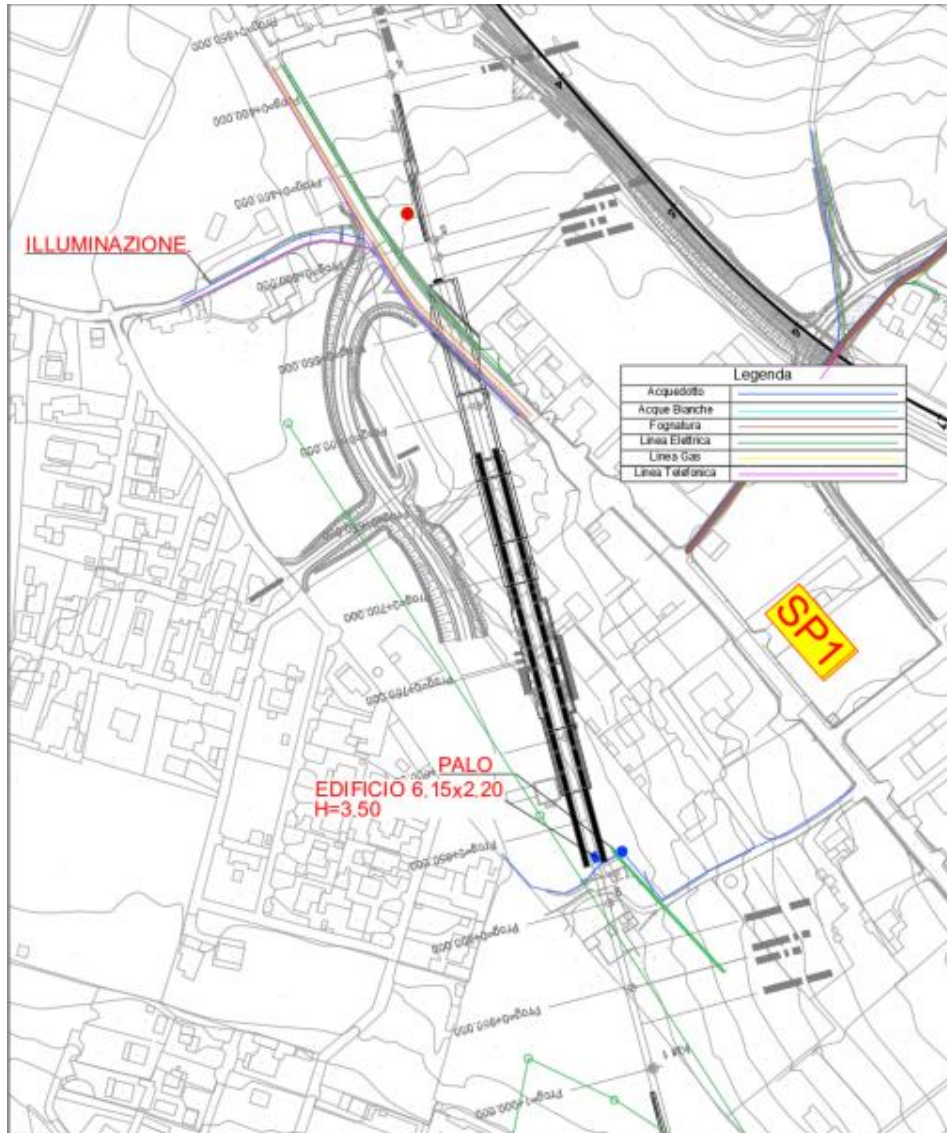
Posizione planimetrica dei sottoservizi nell'area 1
